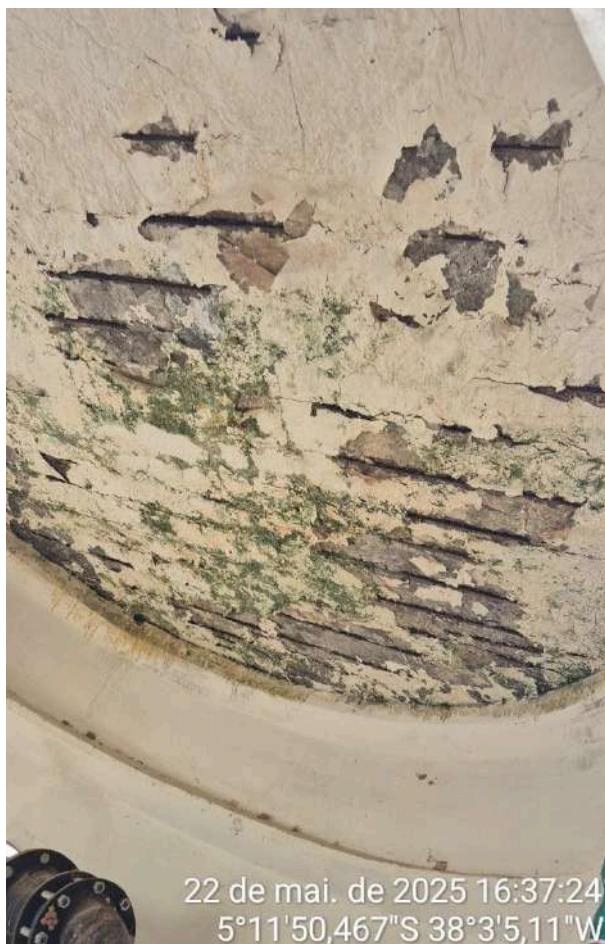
Teto das casas de bomba com armadura expostas e pintura desgastada.
